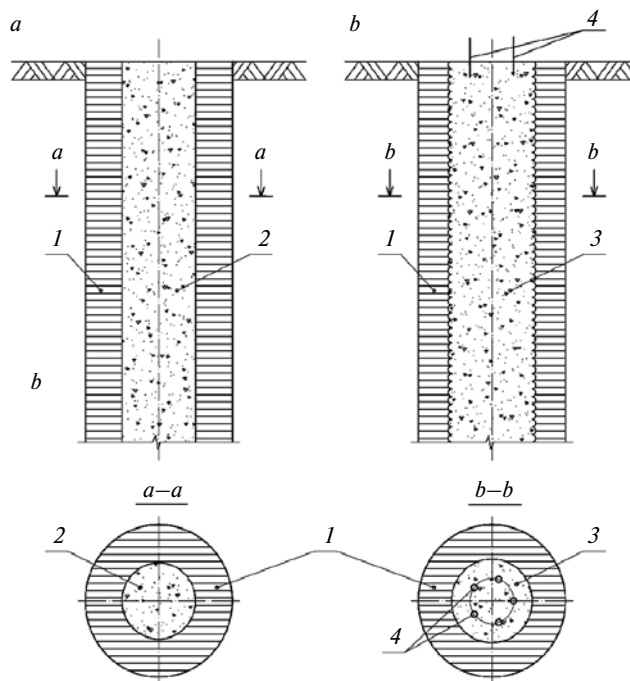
Комбинированная грунтобетонная свая: а – грунтоцементная свая; б – грунтобетонная свая; 1 – грунтоцементная свая; 2 – мелкозернистый бетон в теле грунтоцементной сваи; 3 – армированная буринъекционная свая ЭРТ; а-а – поперечное сечение грунтоцементной сваи; б-б – поперечное сечение грунтобетонной сваи
